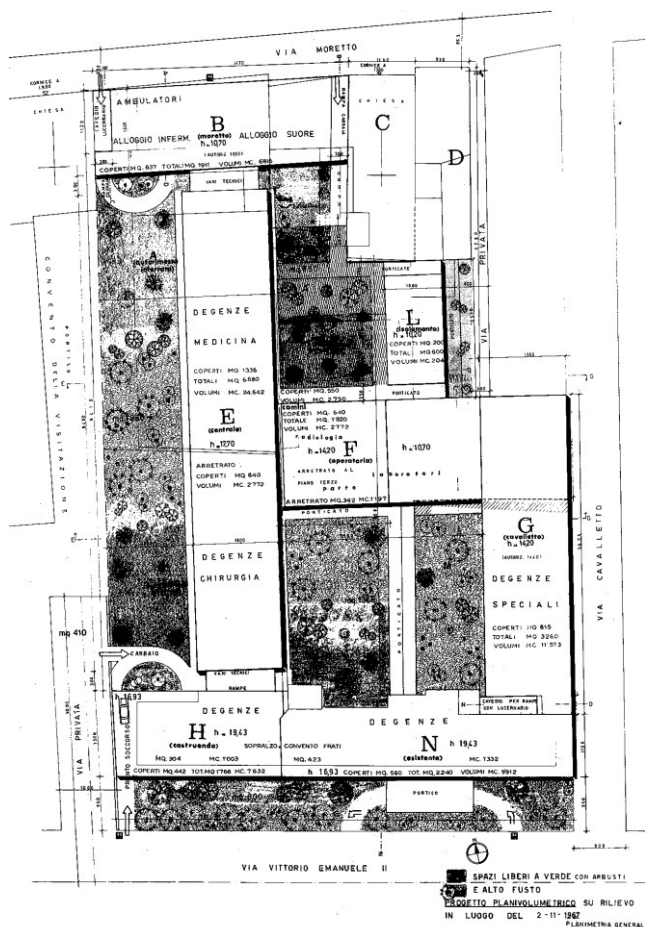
planimetria generale del complesso ospedaliero di Sant'Orsola facente parte del progetto generale del complesso ospedaliero redatto dal Prof. Dott. Arch. Luigi Guagliumi.
